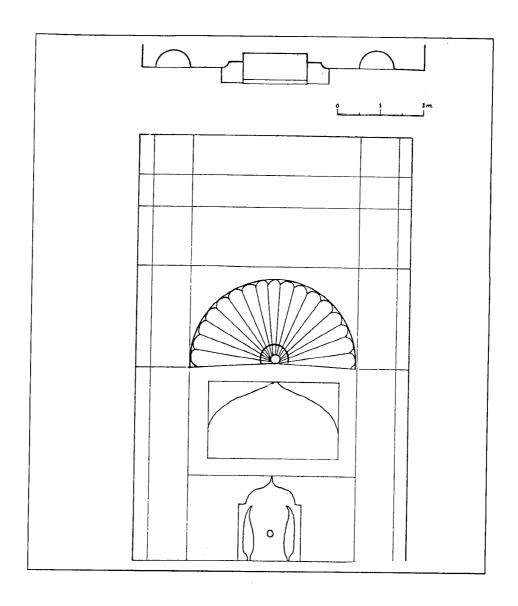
مسقط أفقي پلشمة حسين باشا في أدرنة (عن: ÖNGE).
